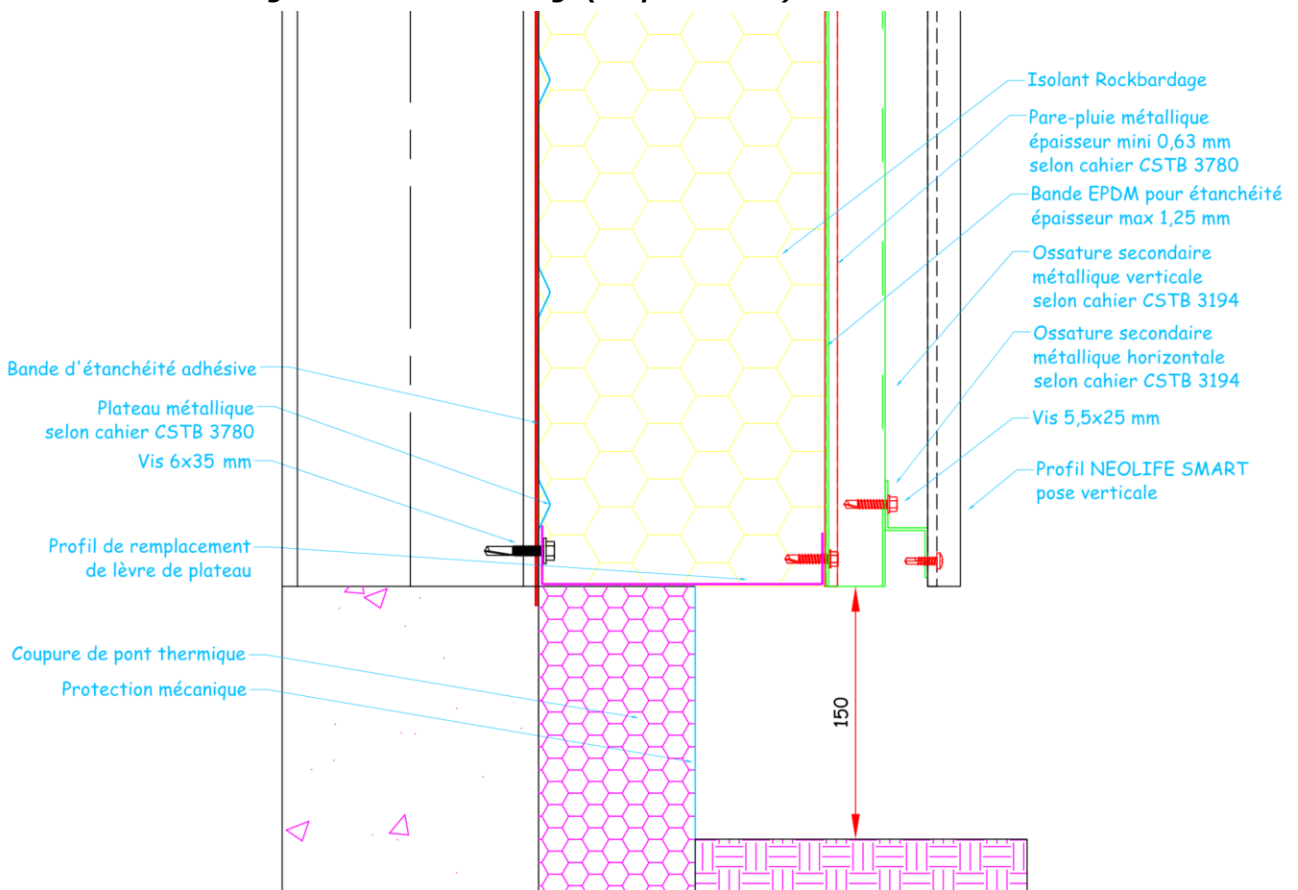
Bas de bardage (coupe verticale) – Pose horizontale
